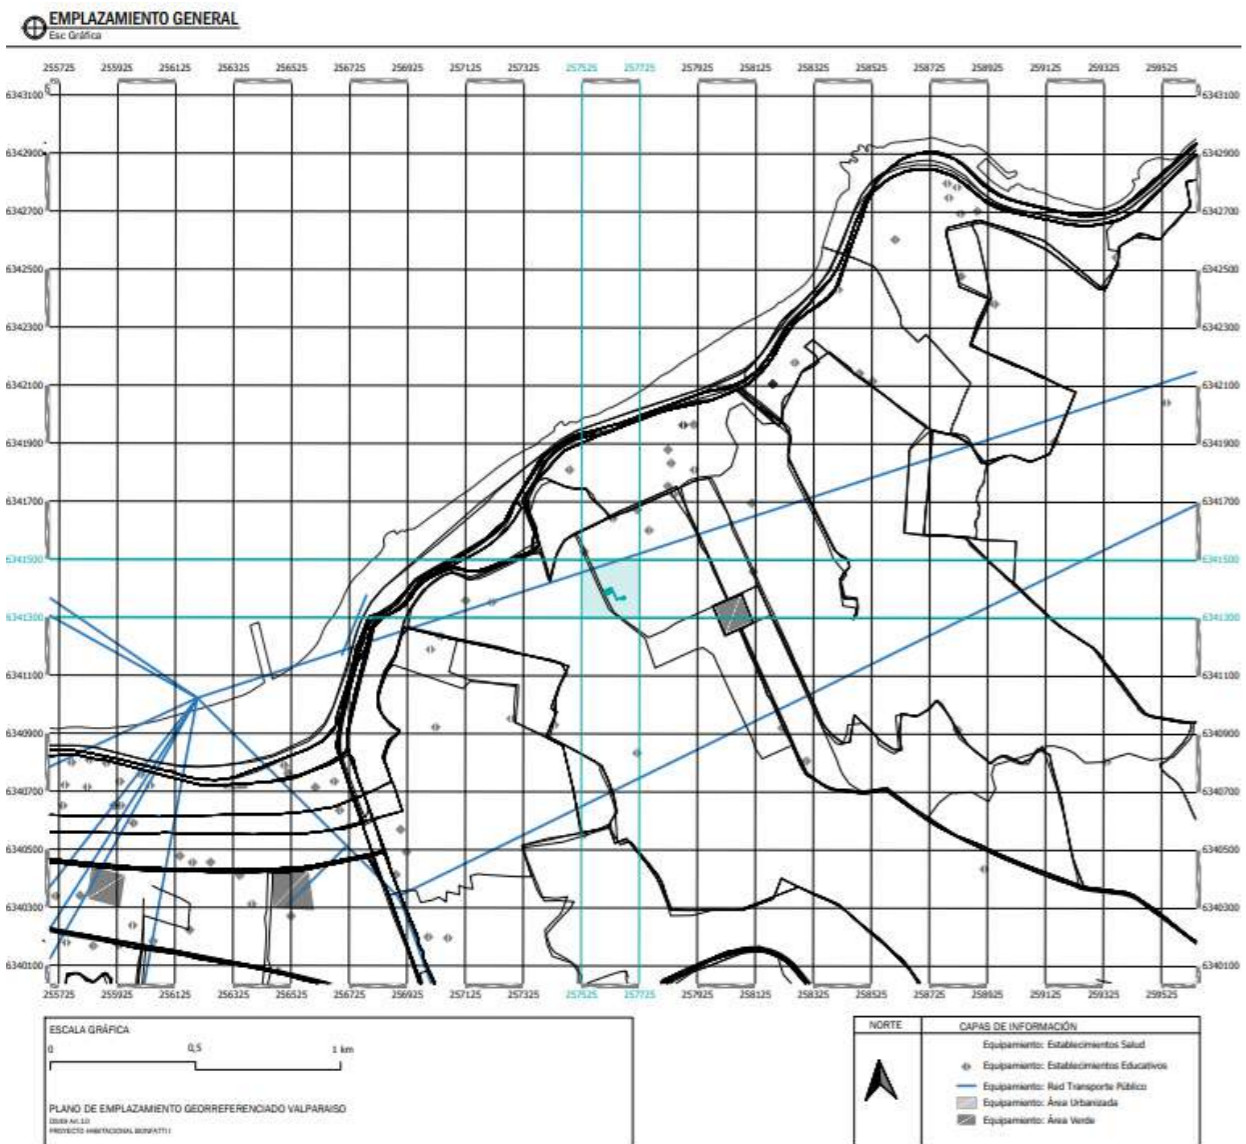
Extracto del plano de emplazamiento georreferenciado del proyecto Bonfatti. Elaboración propia.
